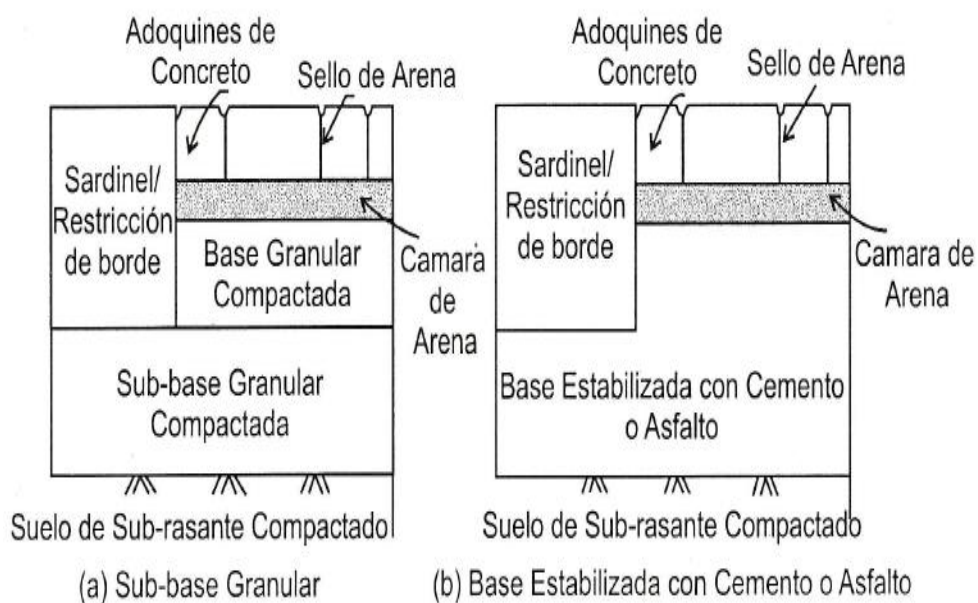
Secciones transversales típicas de pavimentos de adoquines intertrabados
